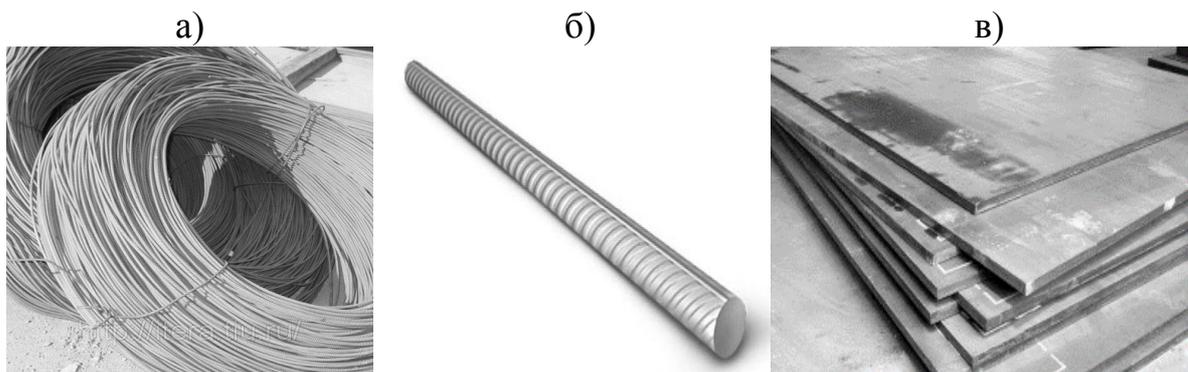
Арматура: а – сталь горячекатаная класса А1; б – прокат свариваемый профиля класса А500С; в – прокат фасонный класса С235
